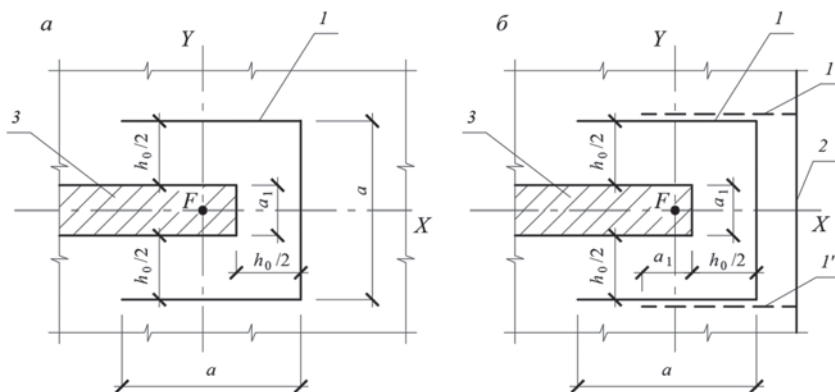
Схемы расчетных контуров поперечного сечения при продавливании плоских плит: а – около стен, расположенных внутри площади плит; б – около стен, расположенных у края плит; 1 – контур расчетного поперечного сечения; 1' – второй вариант расположения контура расчетного поперечного сечения; 2 – край плиты; 3 – площадь приложения нагрузки
